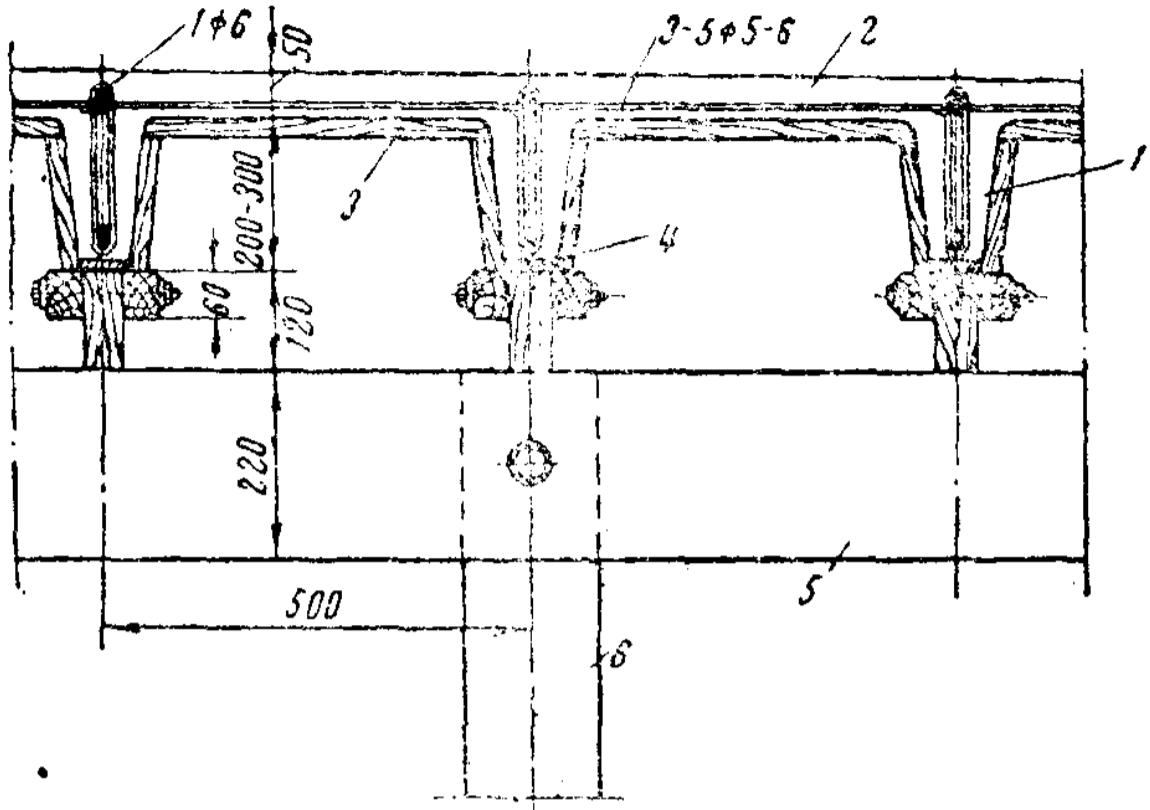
利用輕便模板箱澆灌混凝土的整块密肋楼板
